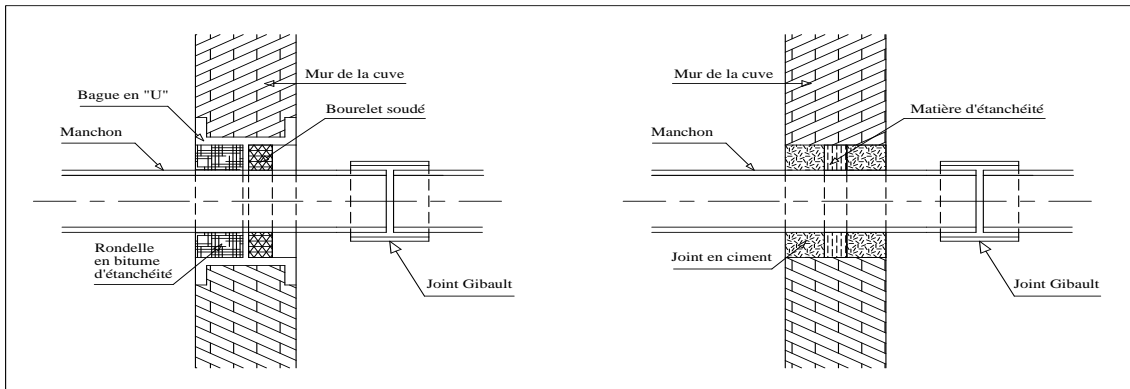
Traversée des conduites (manchon à bout lisse)
